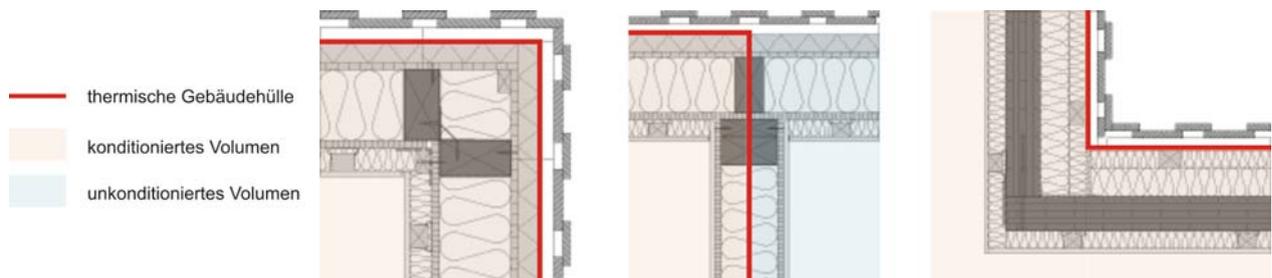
Ermittlung des konditionierten Bruttovolumens, Lage der thermischen Gebäudehülle im Grundriss: Außenecke mit Hinterlüftung (links), Trennwand zwischen konditionierter und unkonditionierter Zone (mittig), Innenecke (rechts). (Quelle der Details: [Holzforschung Austria, 2009])
